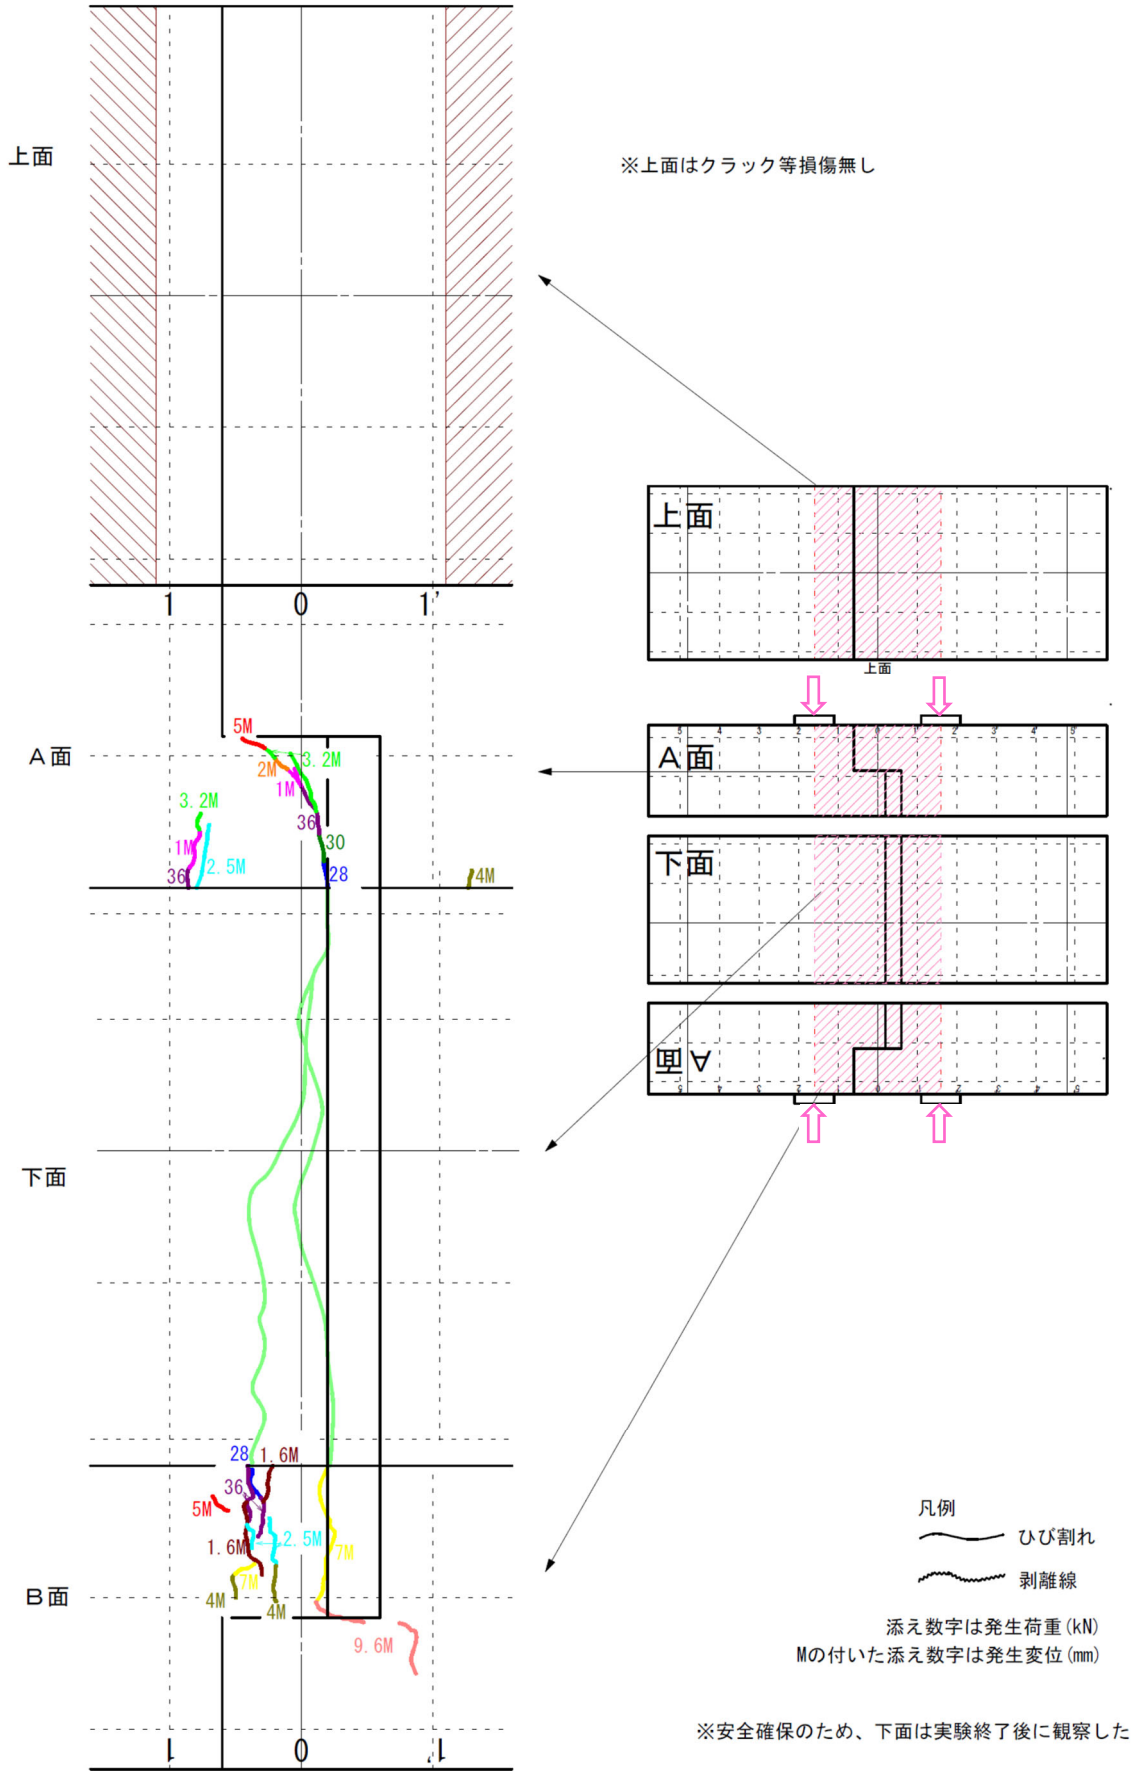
ひび割れ図 (供試体 KF1-1)
